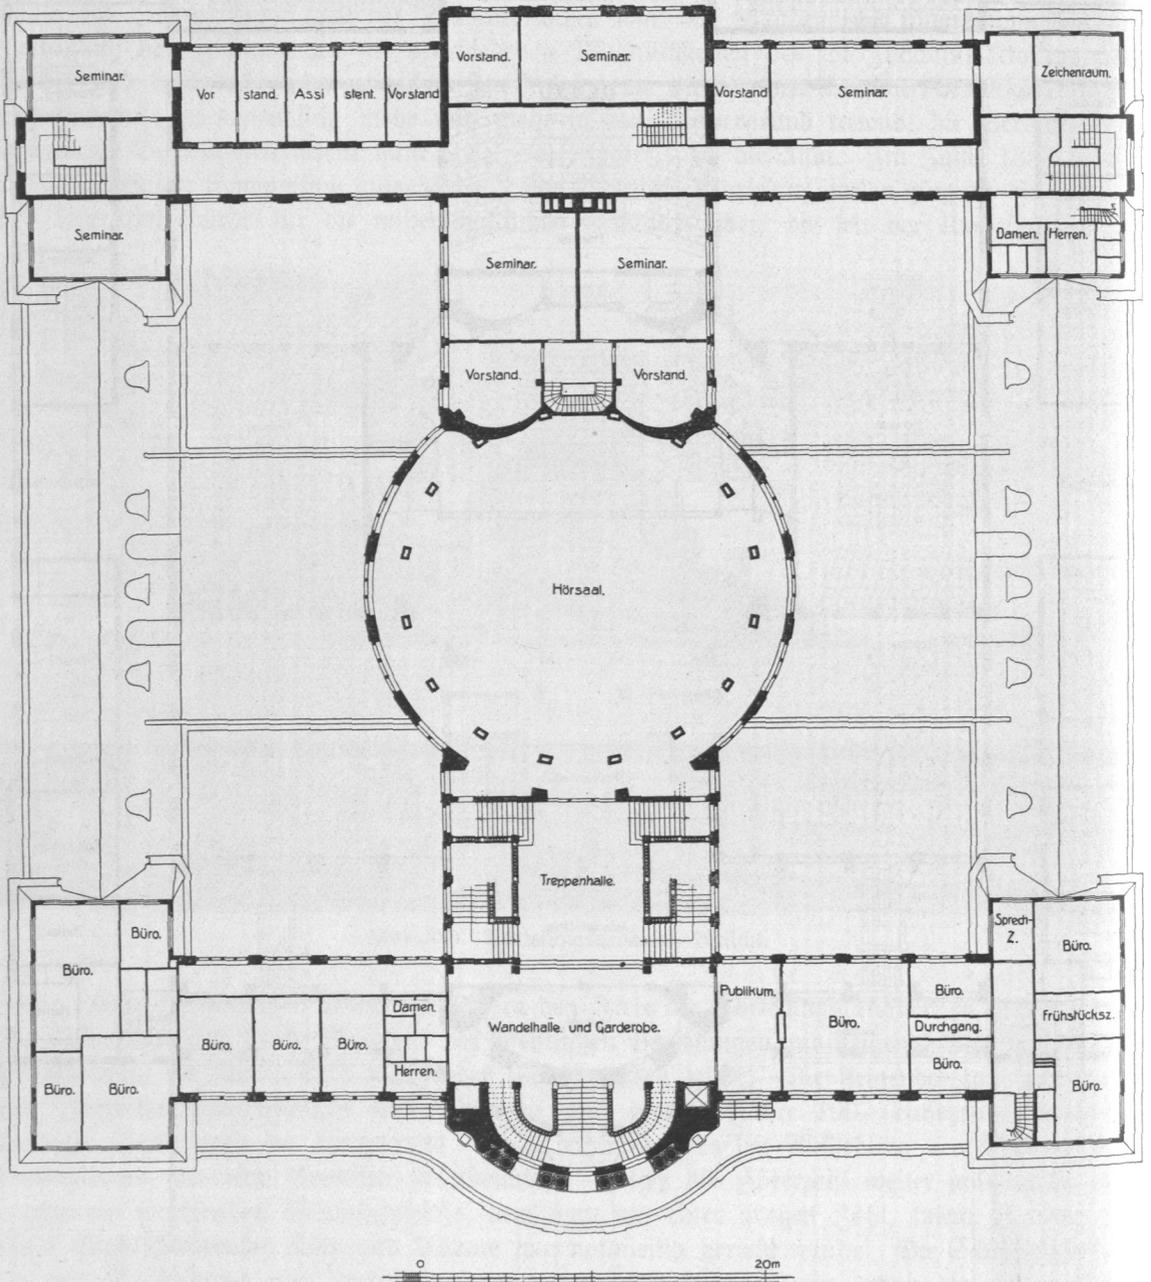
Vorlesungsgebäude, Obergeschoss, Grundriß.
